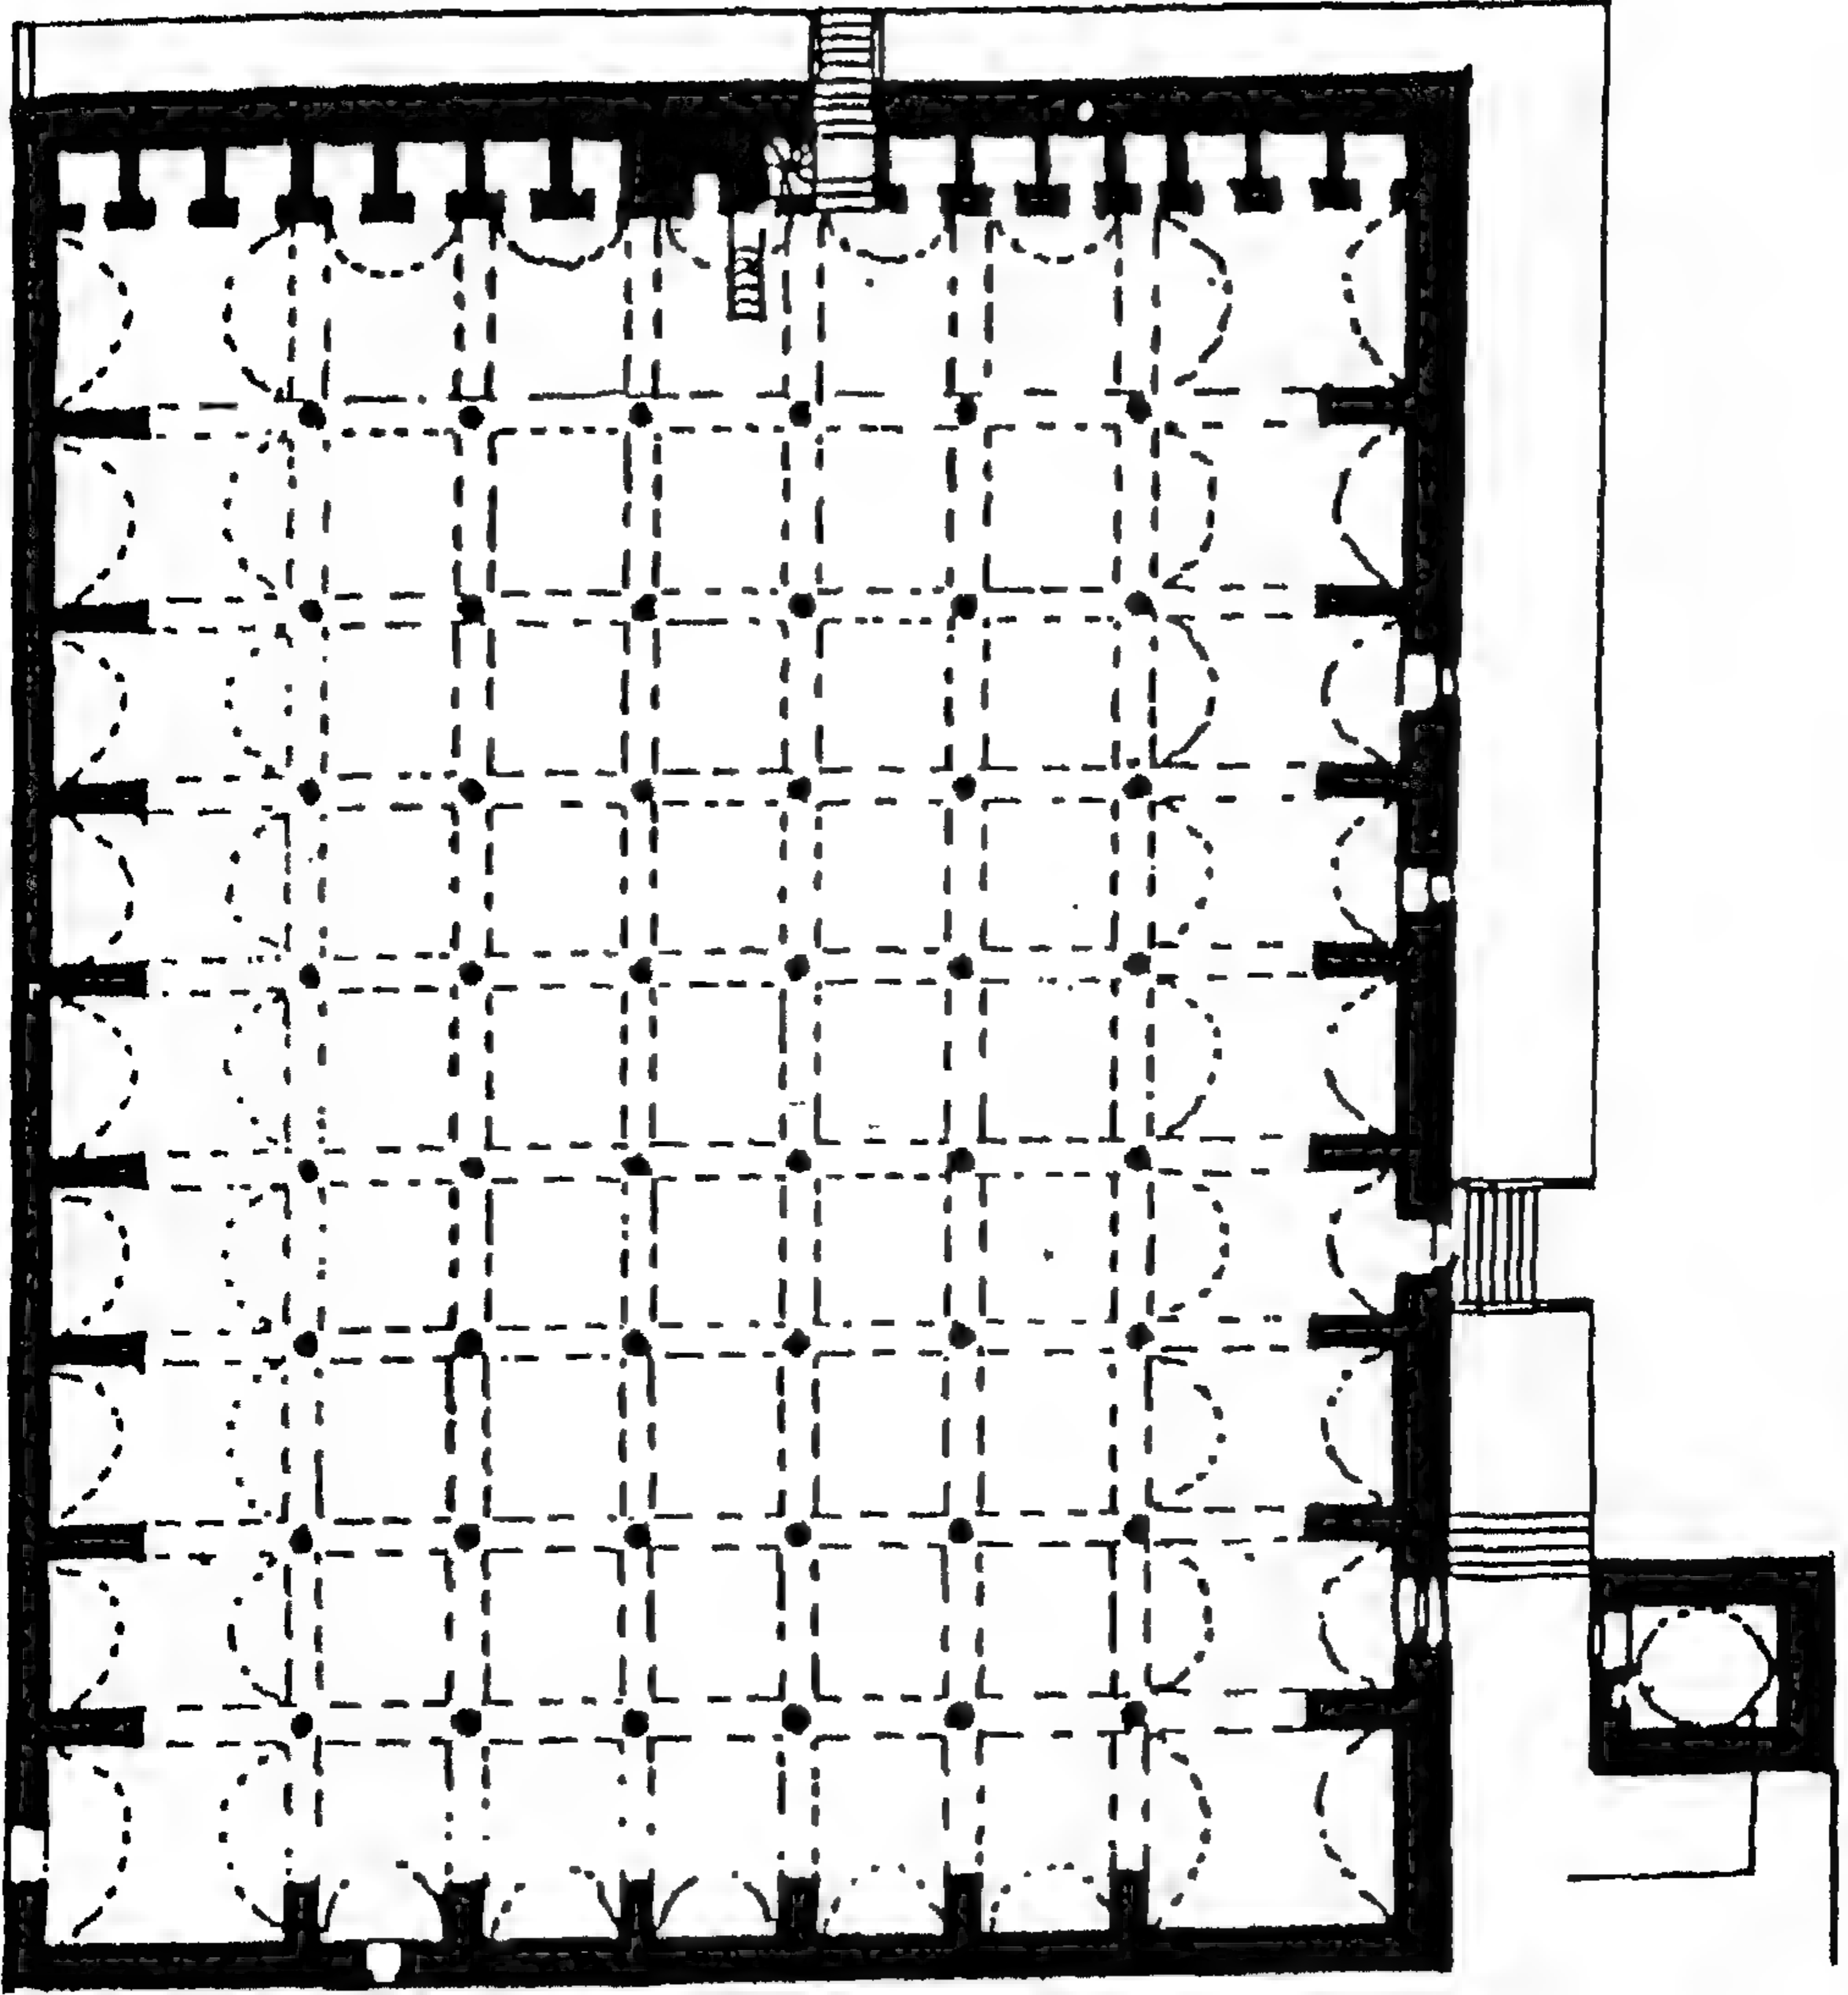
مسقط أفقي لمسجد محمد بن خيرون المعافري المعروف
